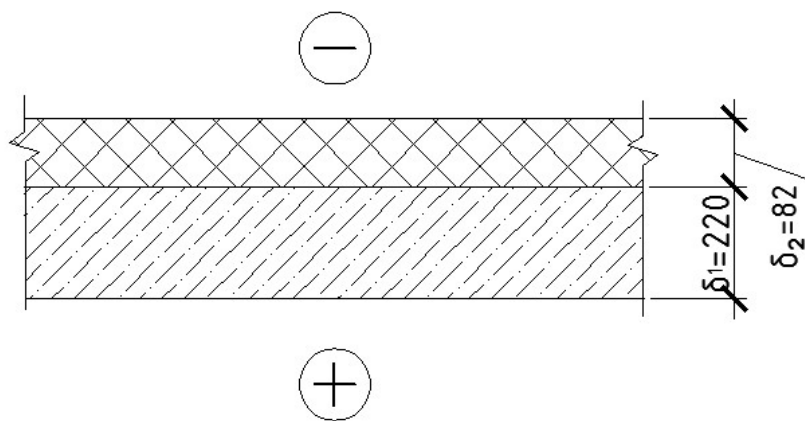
Розрахункова схема перекриття над проїздом
